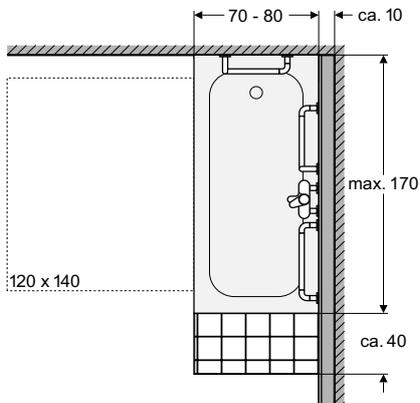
Badewanne, Grundriss mit Bewegungsfläche für Rollstuhlfahrer
